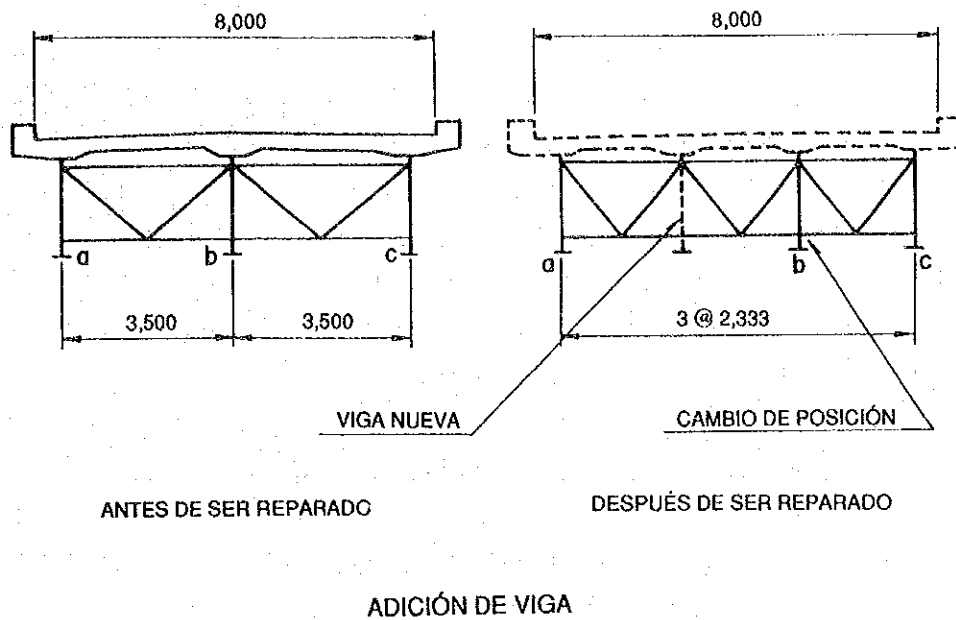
Instalación de una nueva viga de refuerzo entre las vigas existentes
